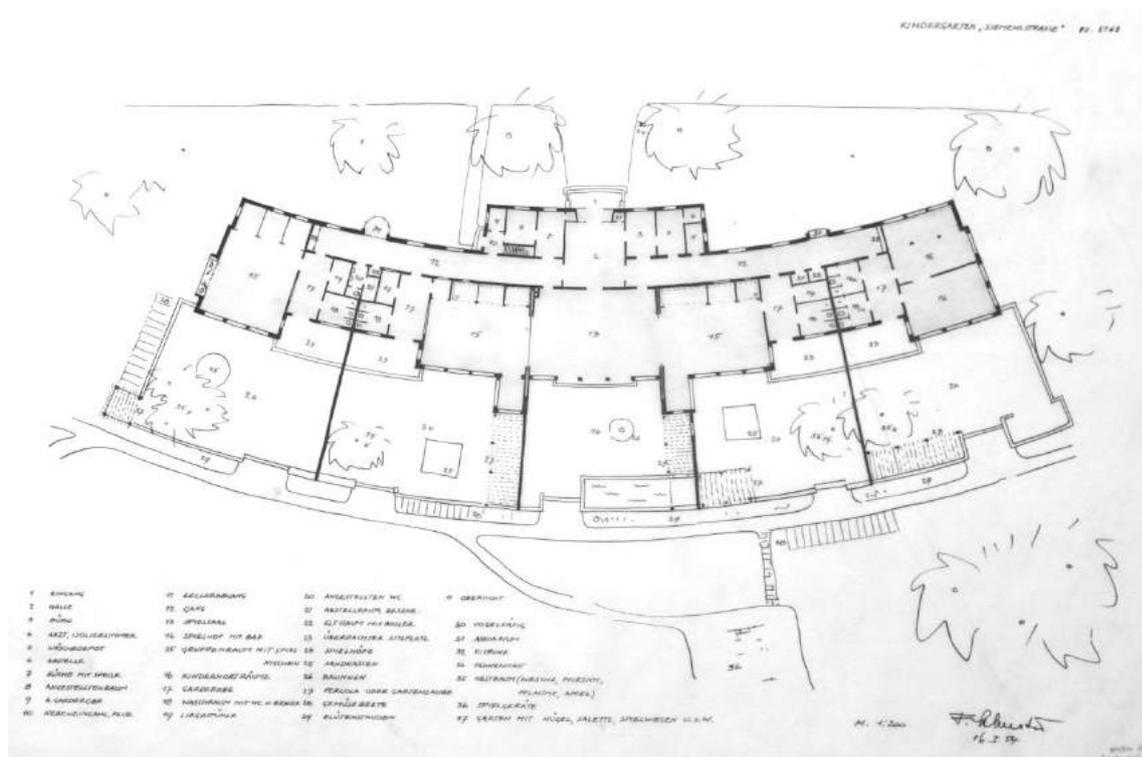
Schusters ursprünglicher Plan des Kindergartens
